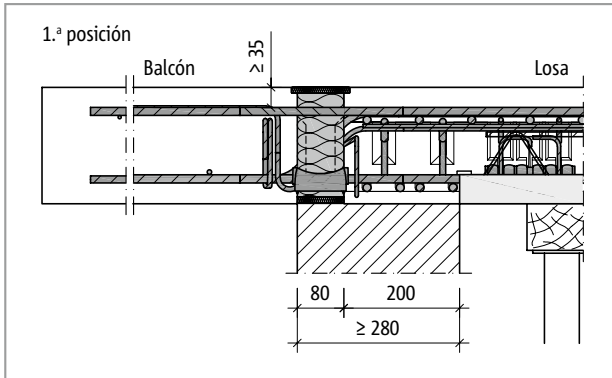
Schöck Isokorb® T tipo C: Placa prefabricada con apoyo periférico con muro aislante (sección T tipo C-CV35-1.ª posición, vista T tipo C-CV50-2.ª posición)
